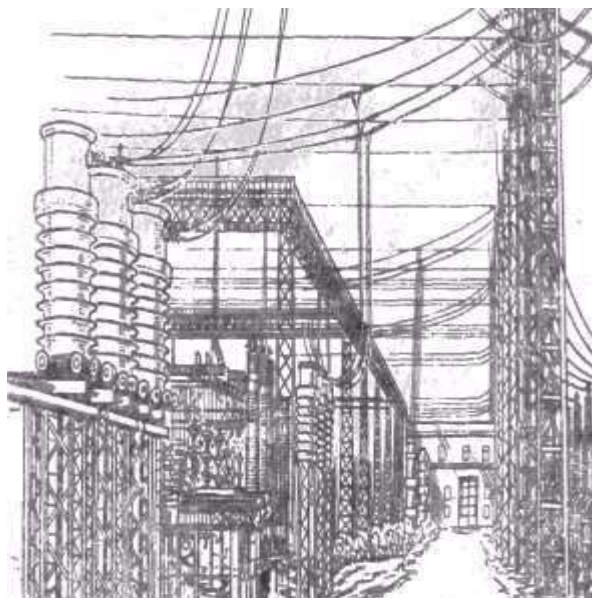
Гнучка ошиновка в РП 220 кВ
